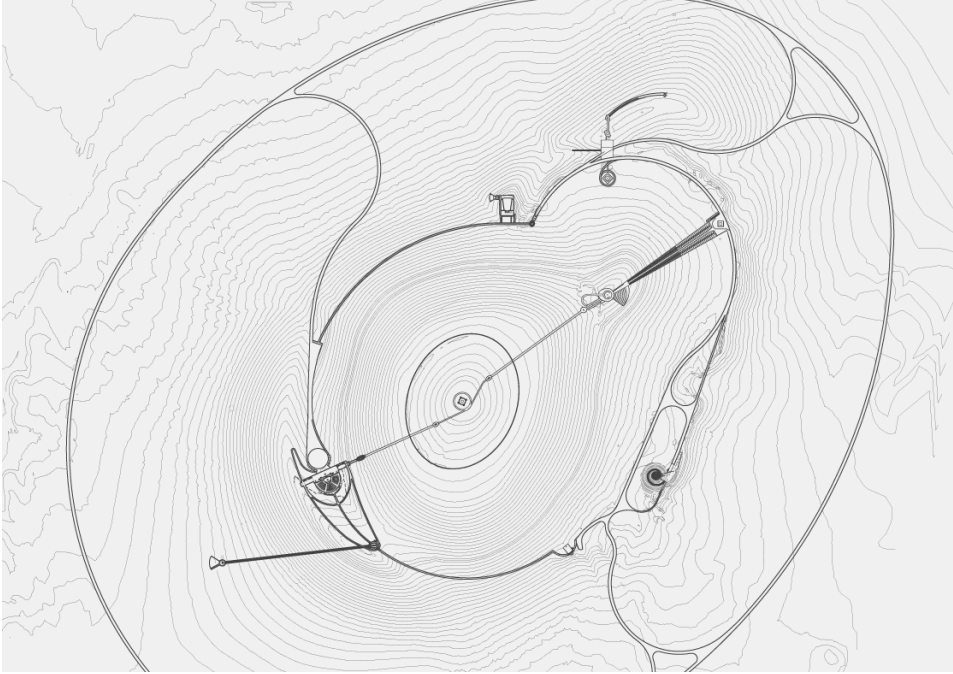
Proyecto Roden Crater. Plano de conjunto.
